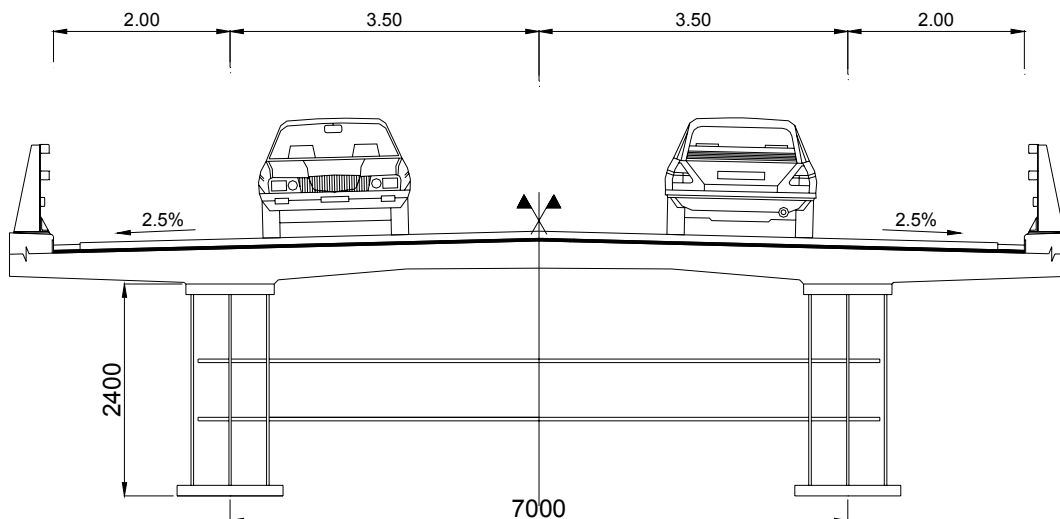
Querschnitt der zweistegigen Plattenbalkenbrücke.
